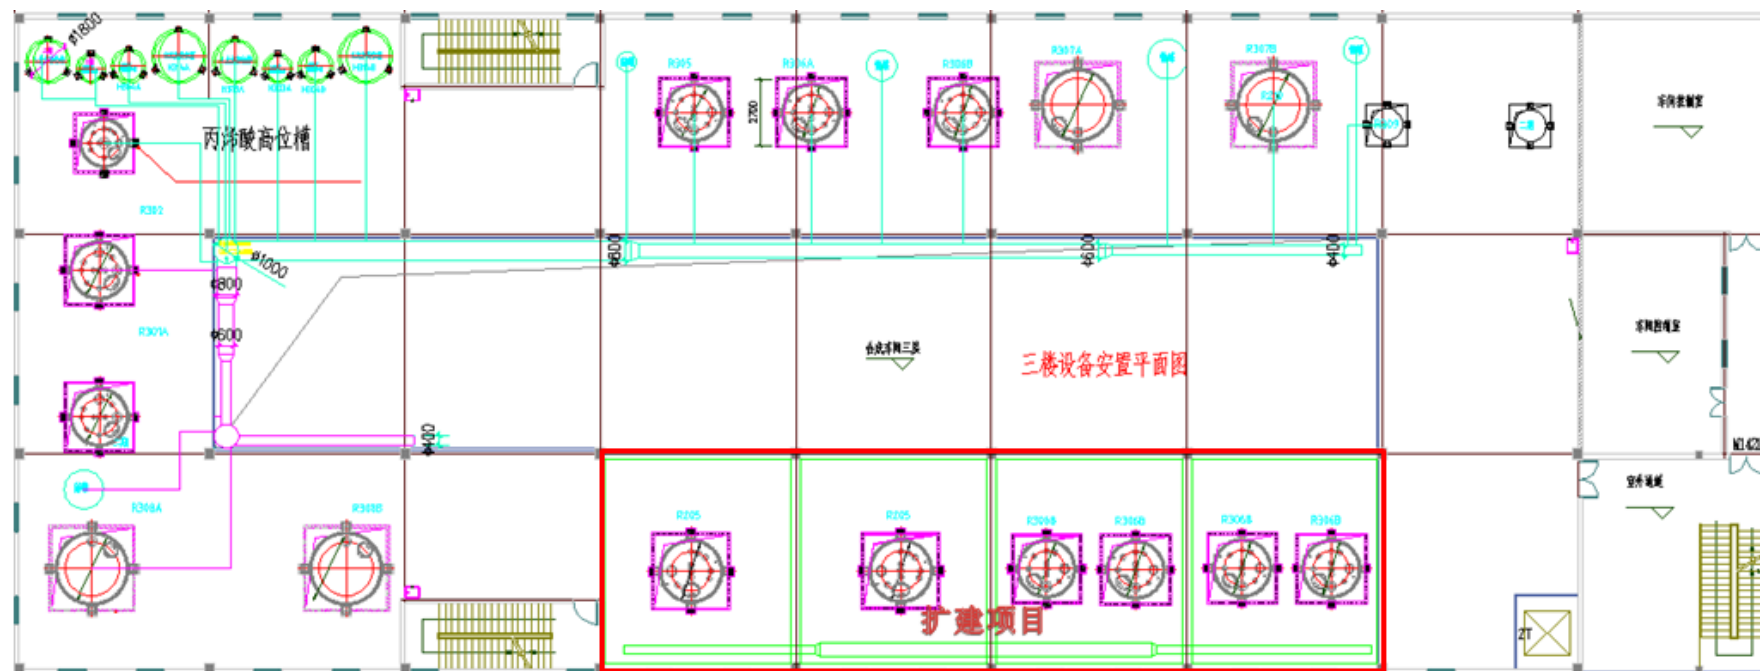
合成车间 3F 扩建项目设备平面布置图
